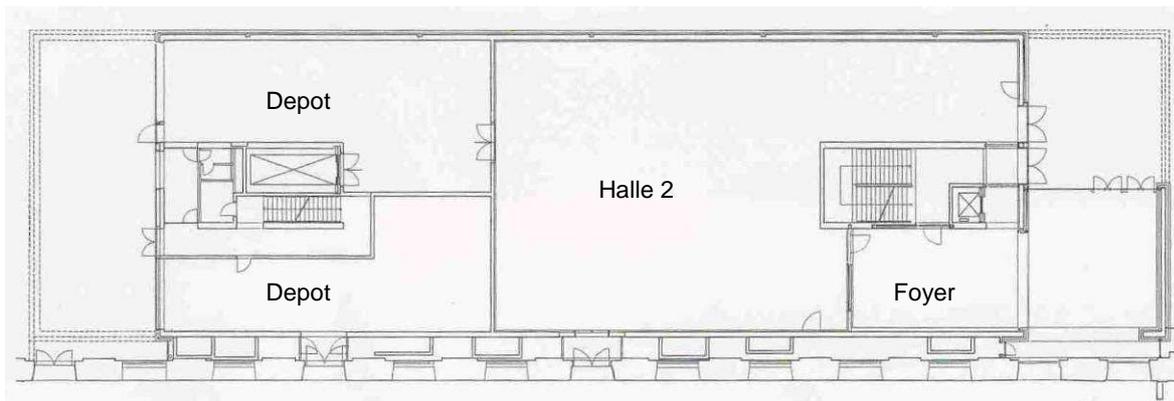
Kunsthalle Wien, Grundriss Erdgeschoß 1:400
